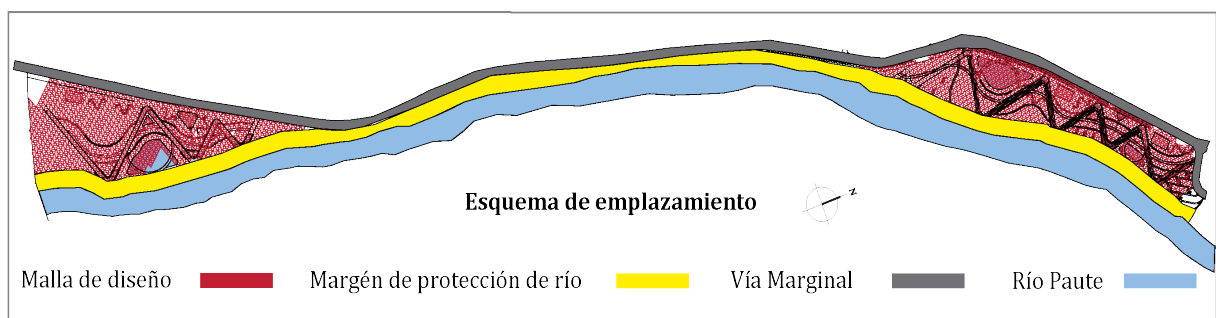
Aplicación de malla en el área de intervención . Fuente y Elaboración: Propia.
